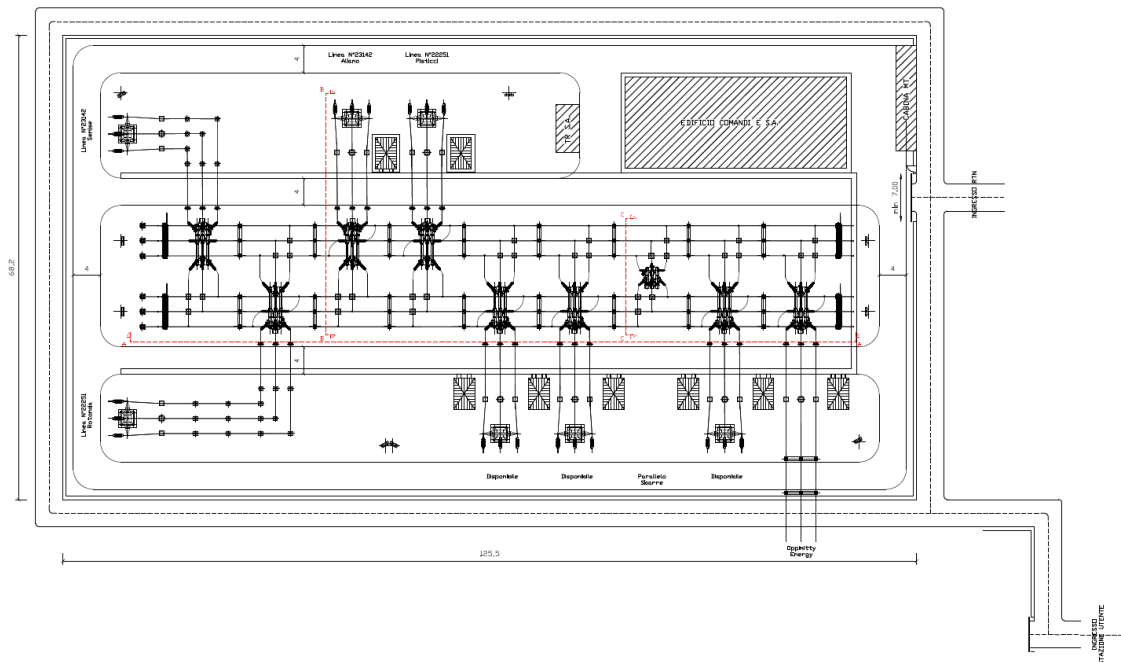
Planimetria SE con l'ubicazione dell'assegnazione degli stalli
